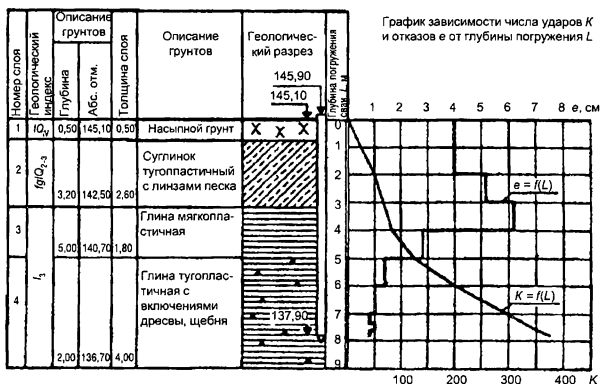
Результаты испытания эталонной сваи динамическими нагрузками
